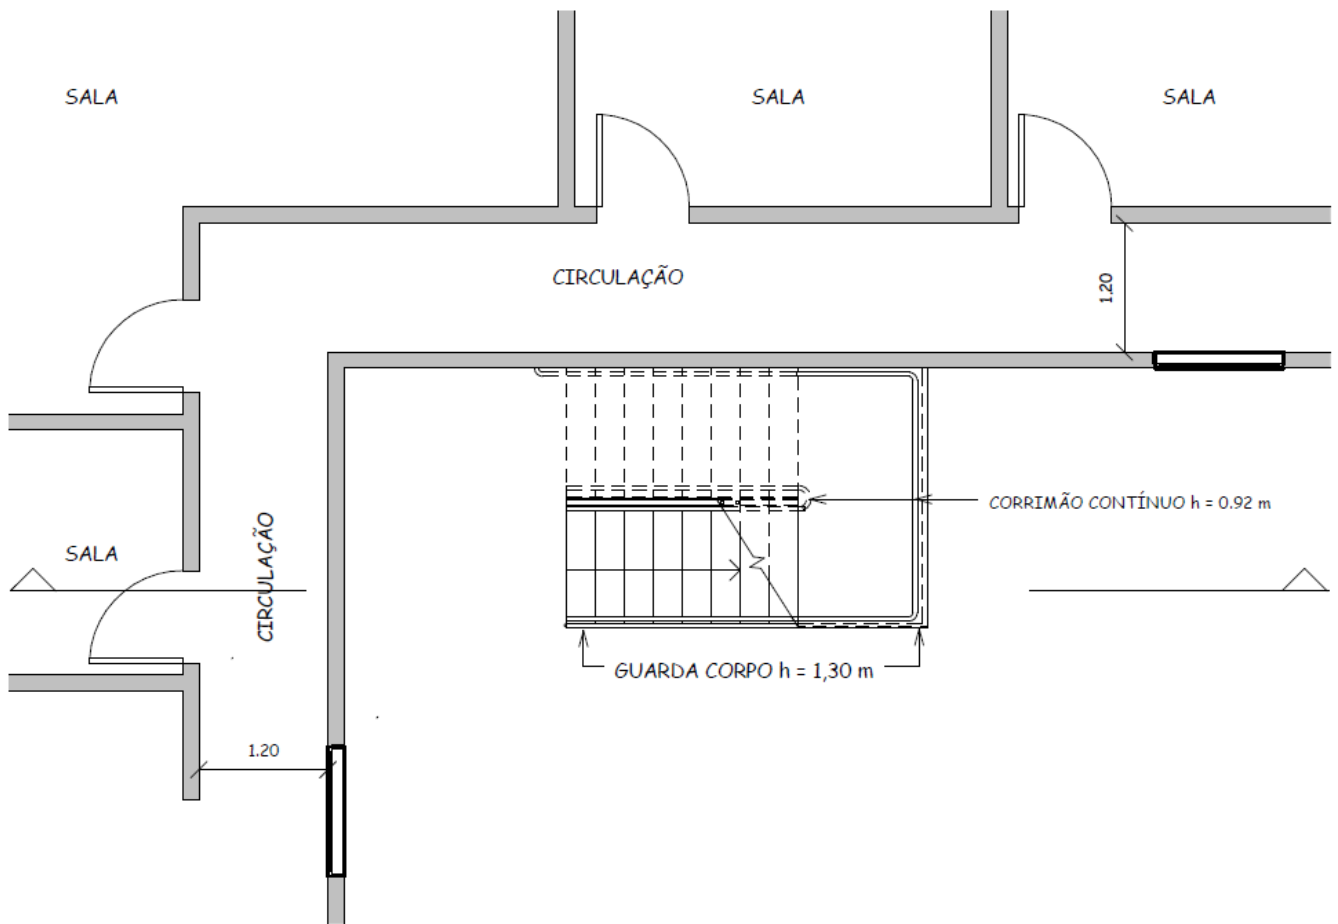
A - Escada aberta externa - térreo (planta baixa).
